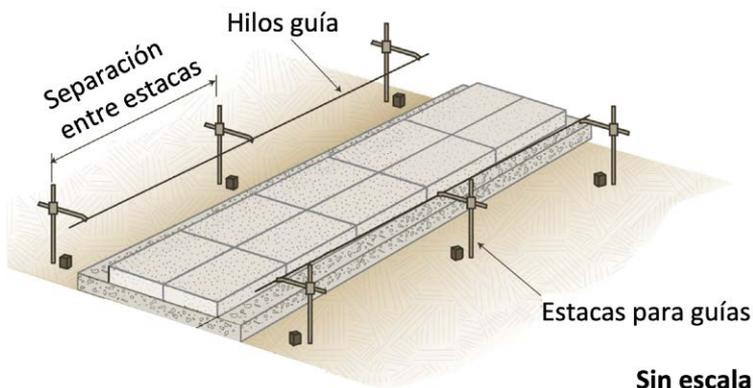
Ubicación de estacas e hilos guía para pavimentadora de encofrados deslizantes
